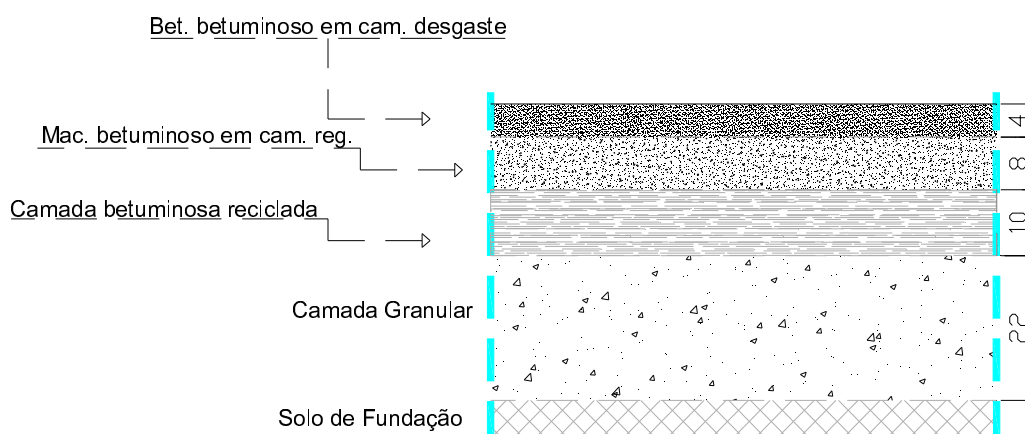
Estrutura do pavimento da Rua Cónego Dr. Manuel Faria para a alternativa de reciclagem *in situ* com espuma de betume
